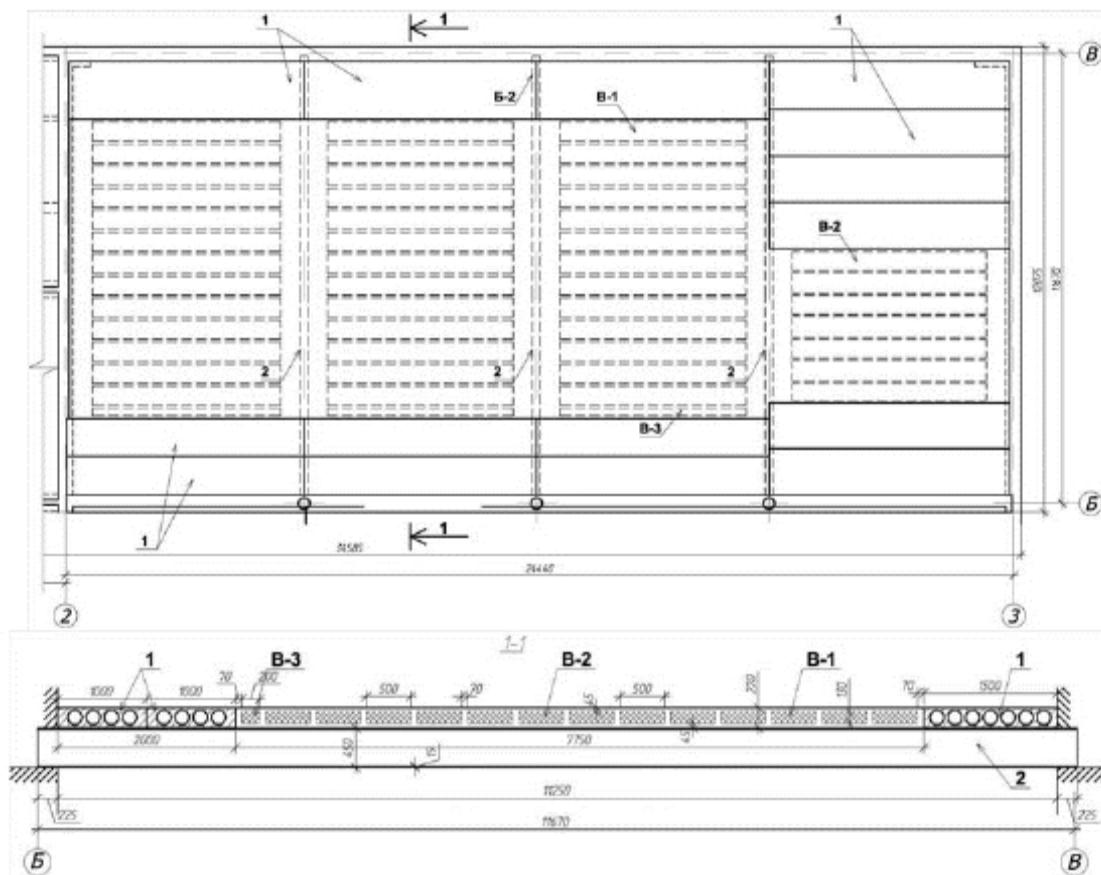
Поперечний переріз залізобетонного перекриття хмарочосу
